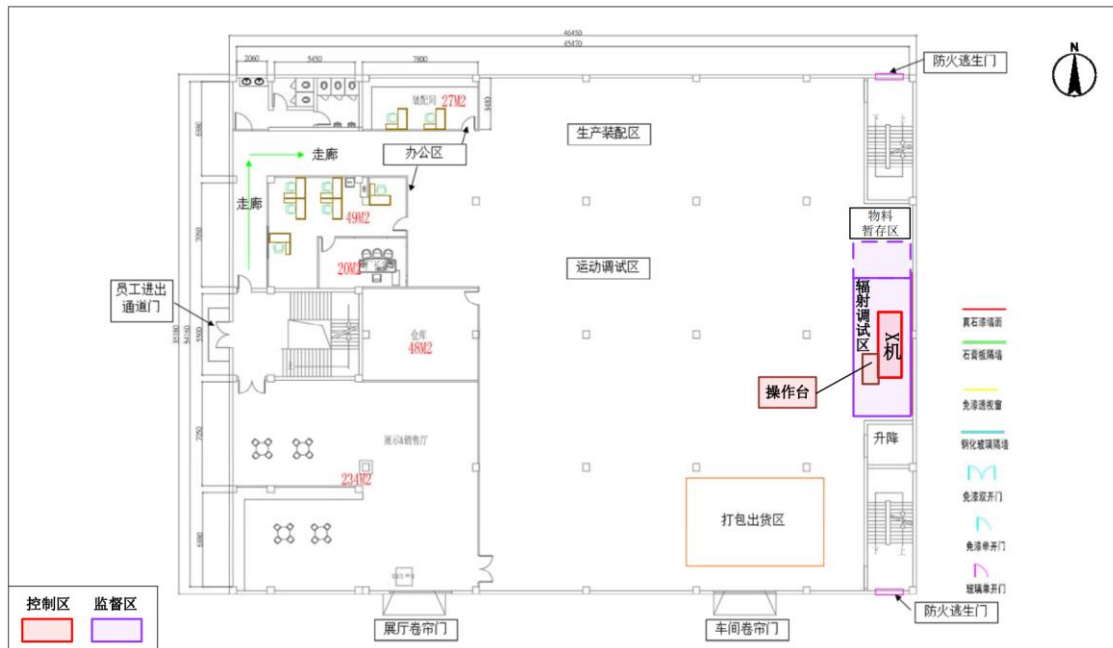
厂房一层平面布置及辐射防护分区划分示意图
